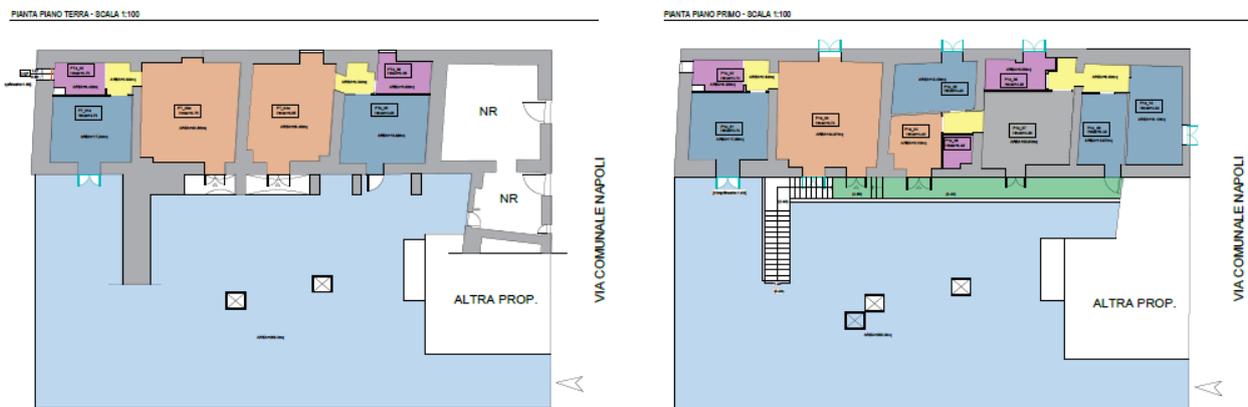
Rilievo funzionale edificio A (pianta piano terra a sinistra, pianta primo piano a destra)
